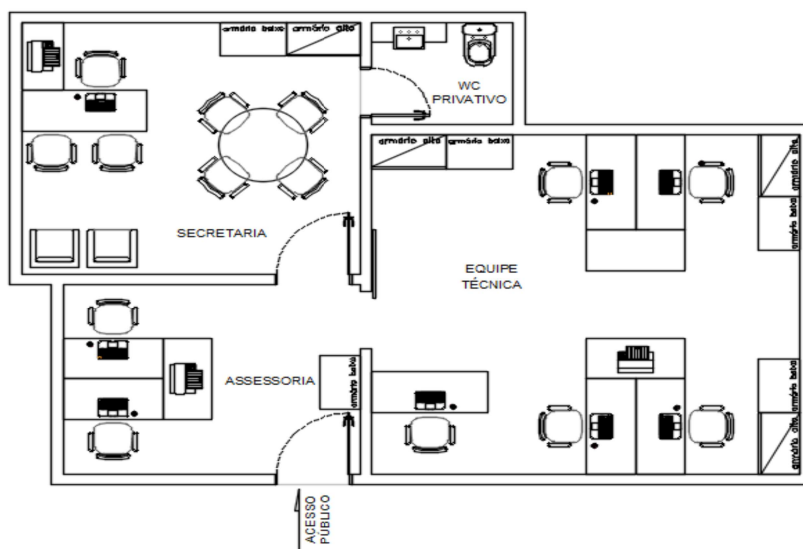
Croqui Layout esquemático da Secretaria-Geral da CGJ
